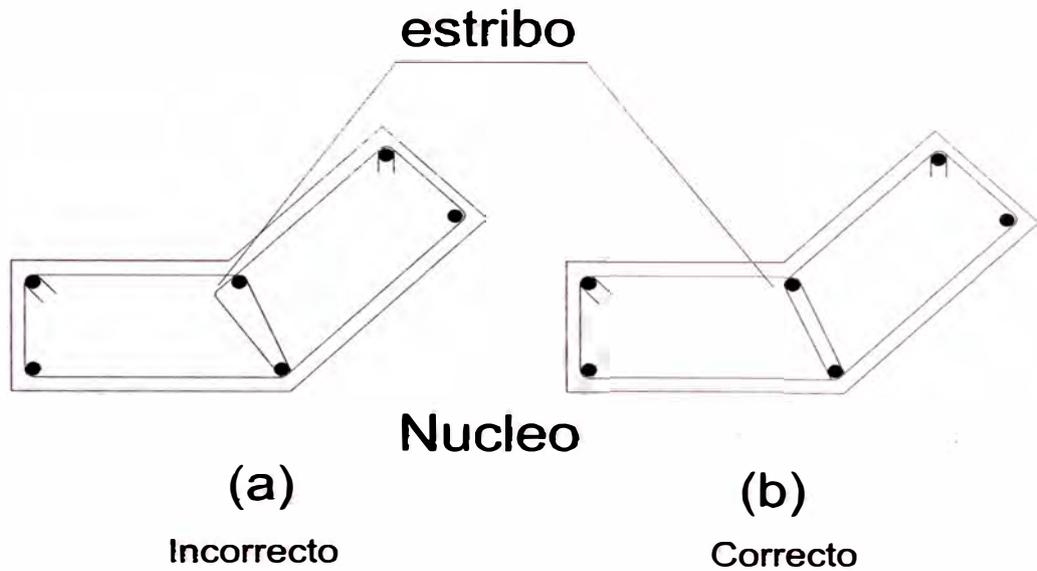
Detalle de amarre de estribos. Nótese que en (a) existe un espacio libre entre el refuerzo vertical y el estribo. En el caso (b) se corrige.
